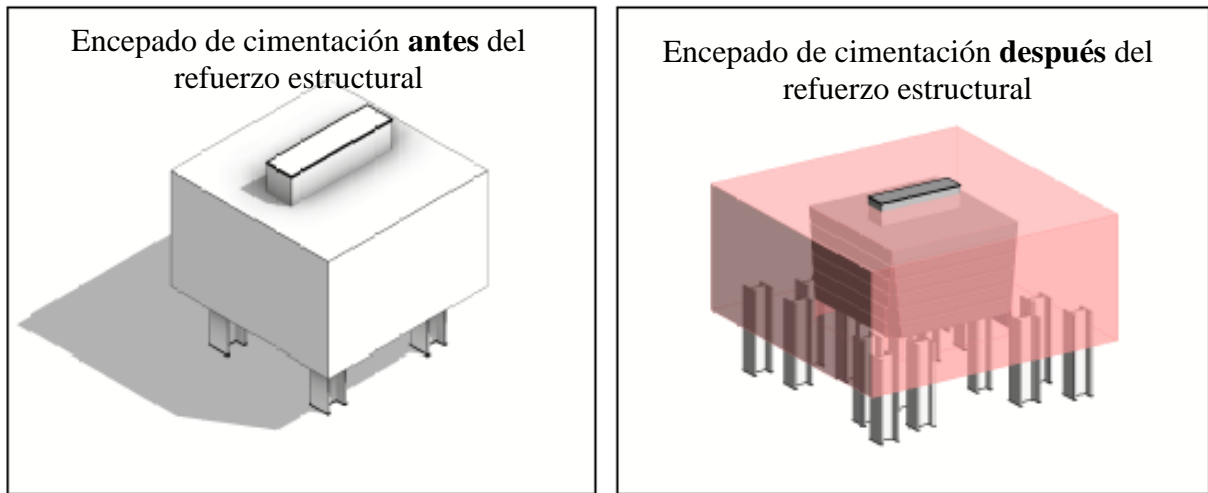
Detalle genérico en perspectiva (antes y después) del refuerzo estructural de los encepados de cimentación.
